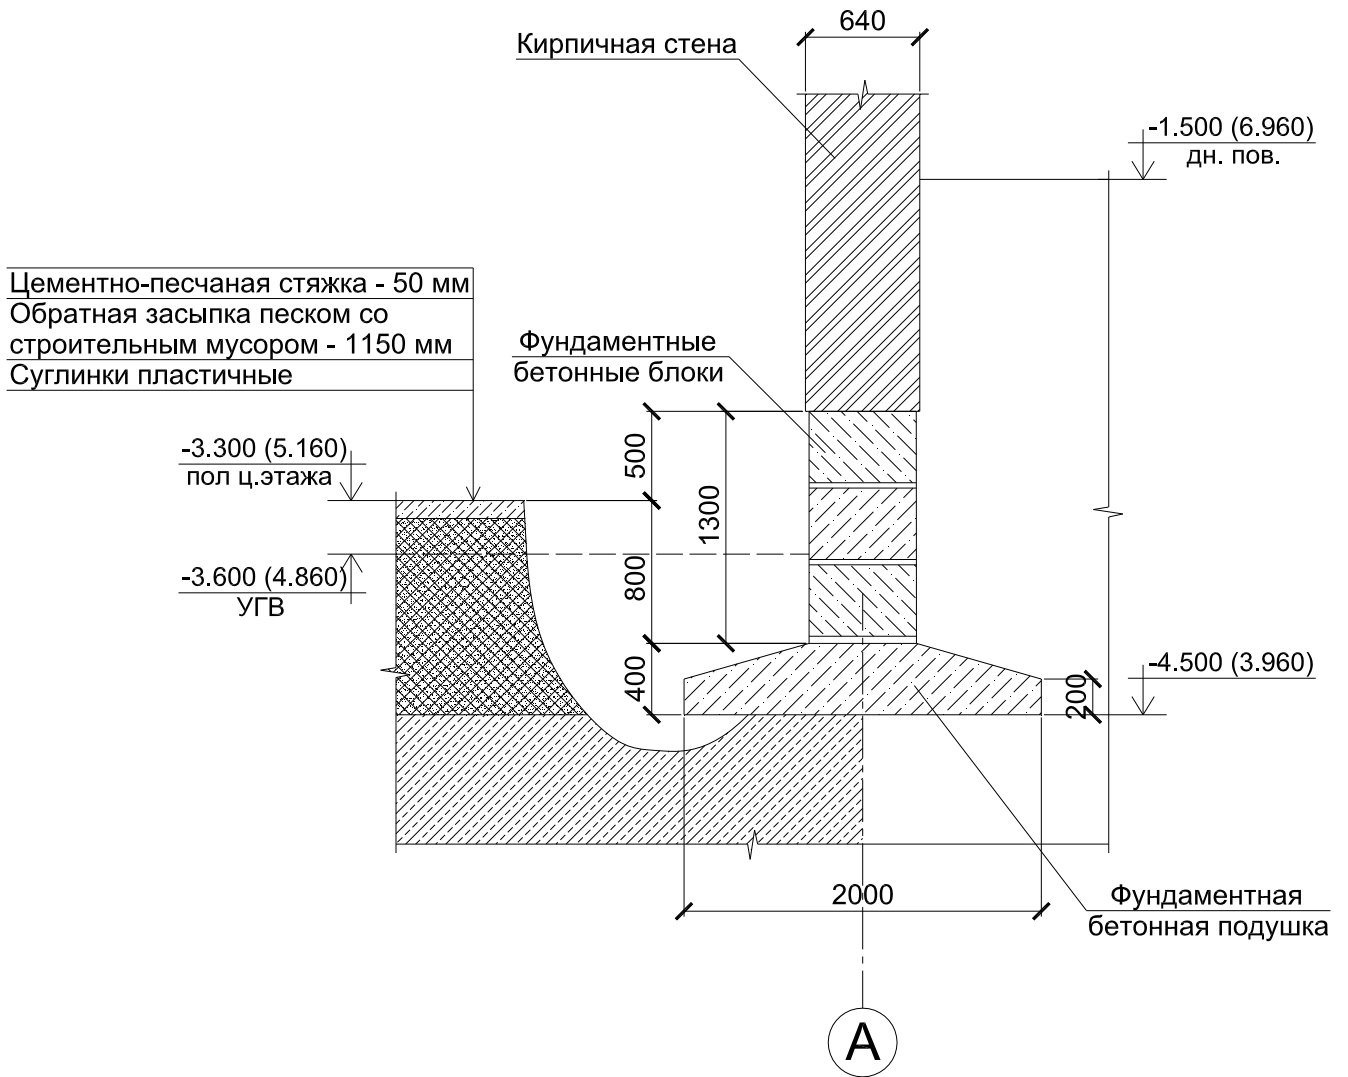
Эскиз поперечного сечения фундамента.
